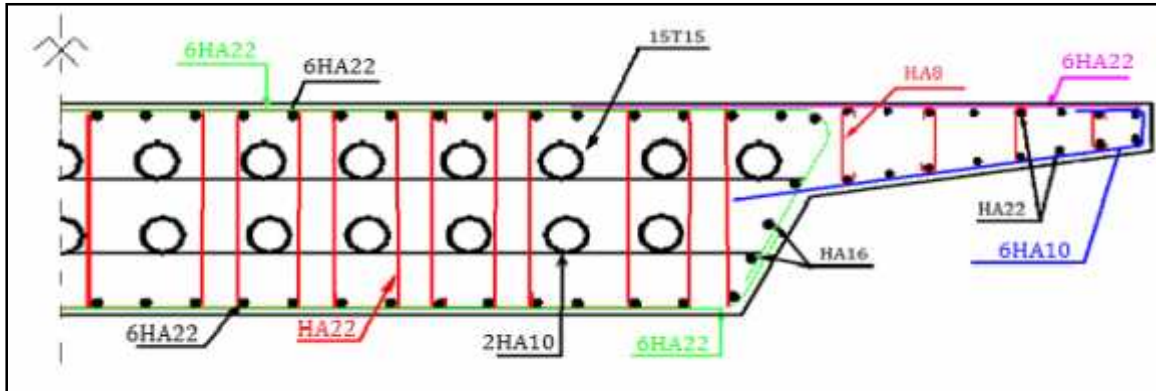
Schéma de ferrailage sur appui intermédiaire.
